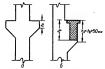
94. Консоли для опирания подкрановых балок: a - c f o p h h x; f - h o h o p h r h h x.
